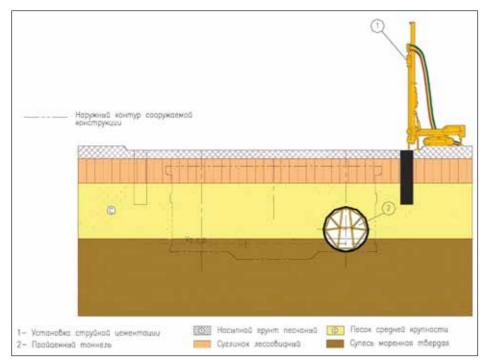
Устройство крепления котлована грунтоцементными сваями
